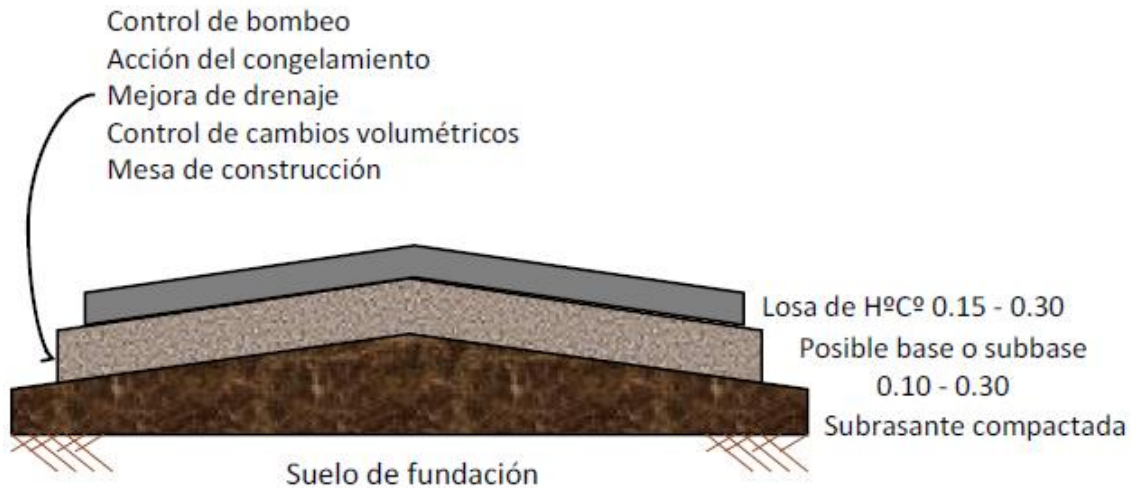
Perfil Tipo: Pavimento Rígido
